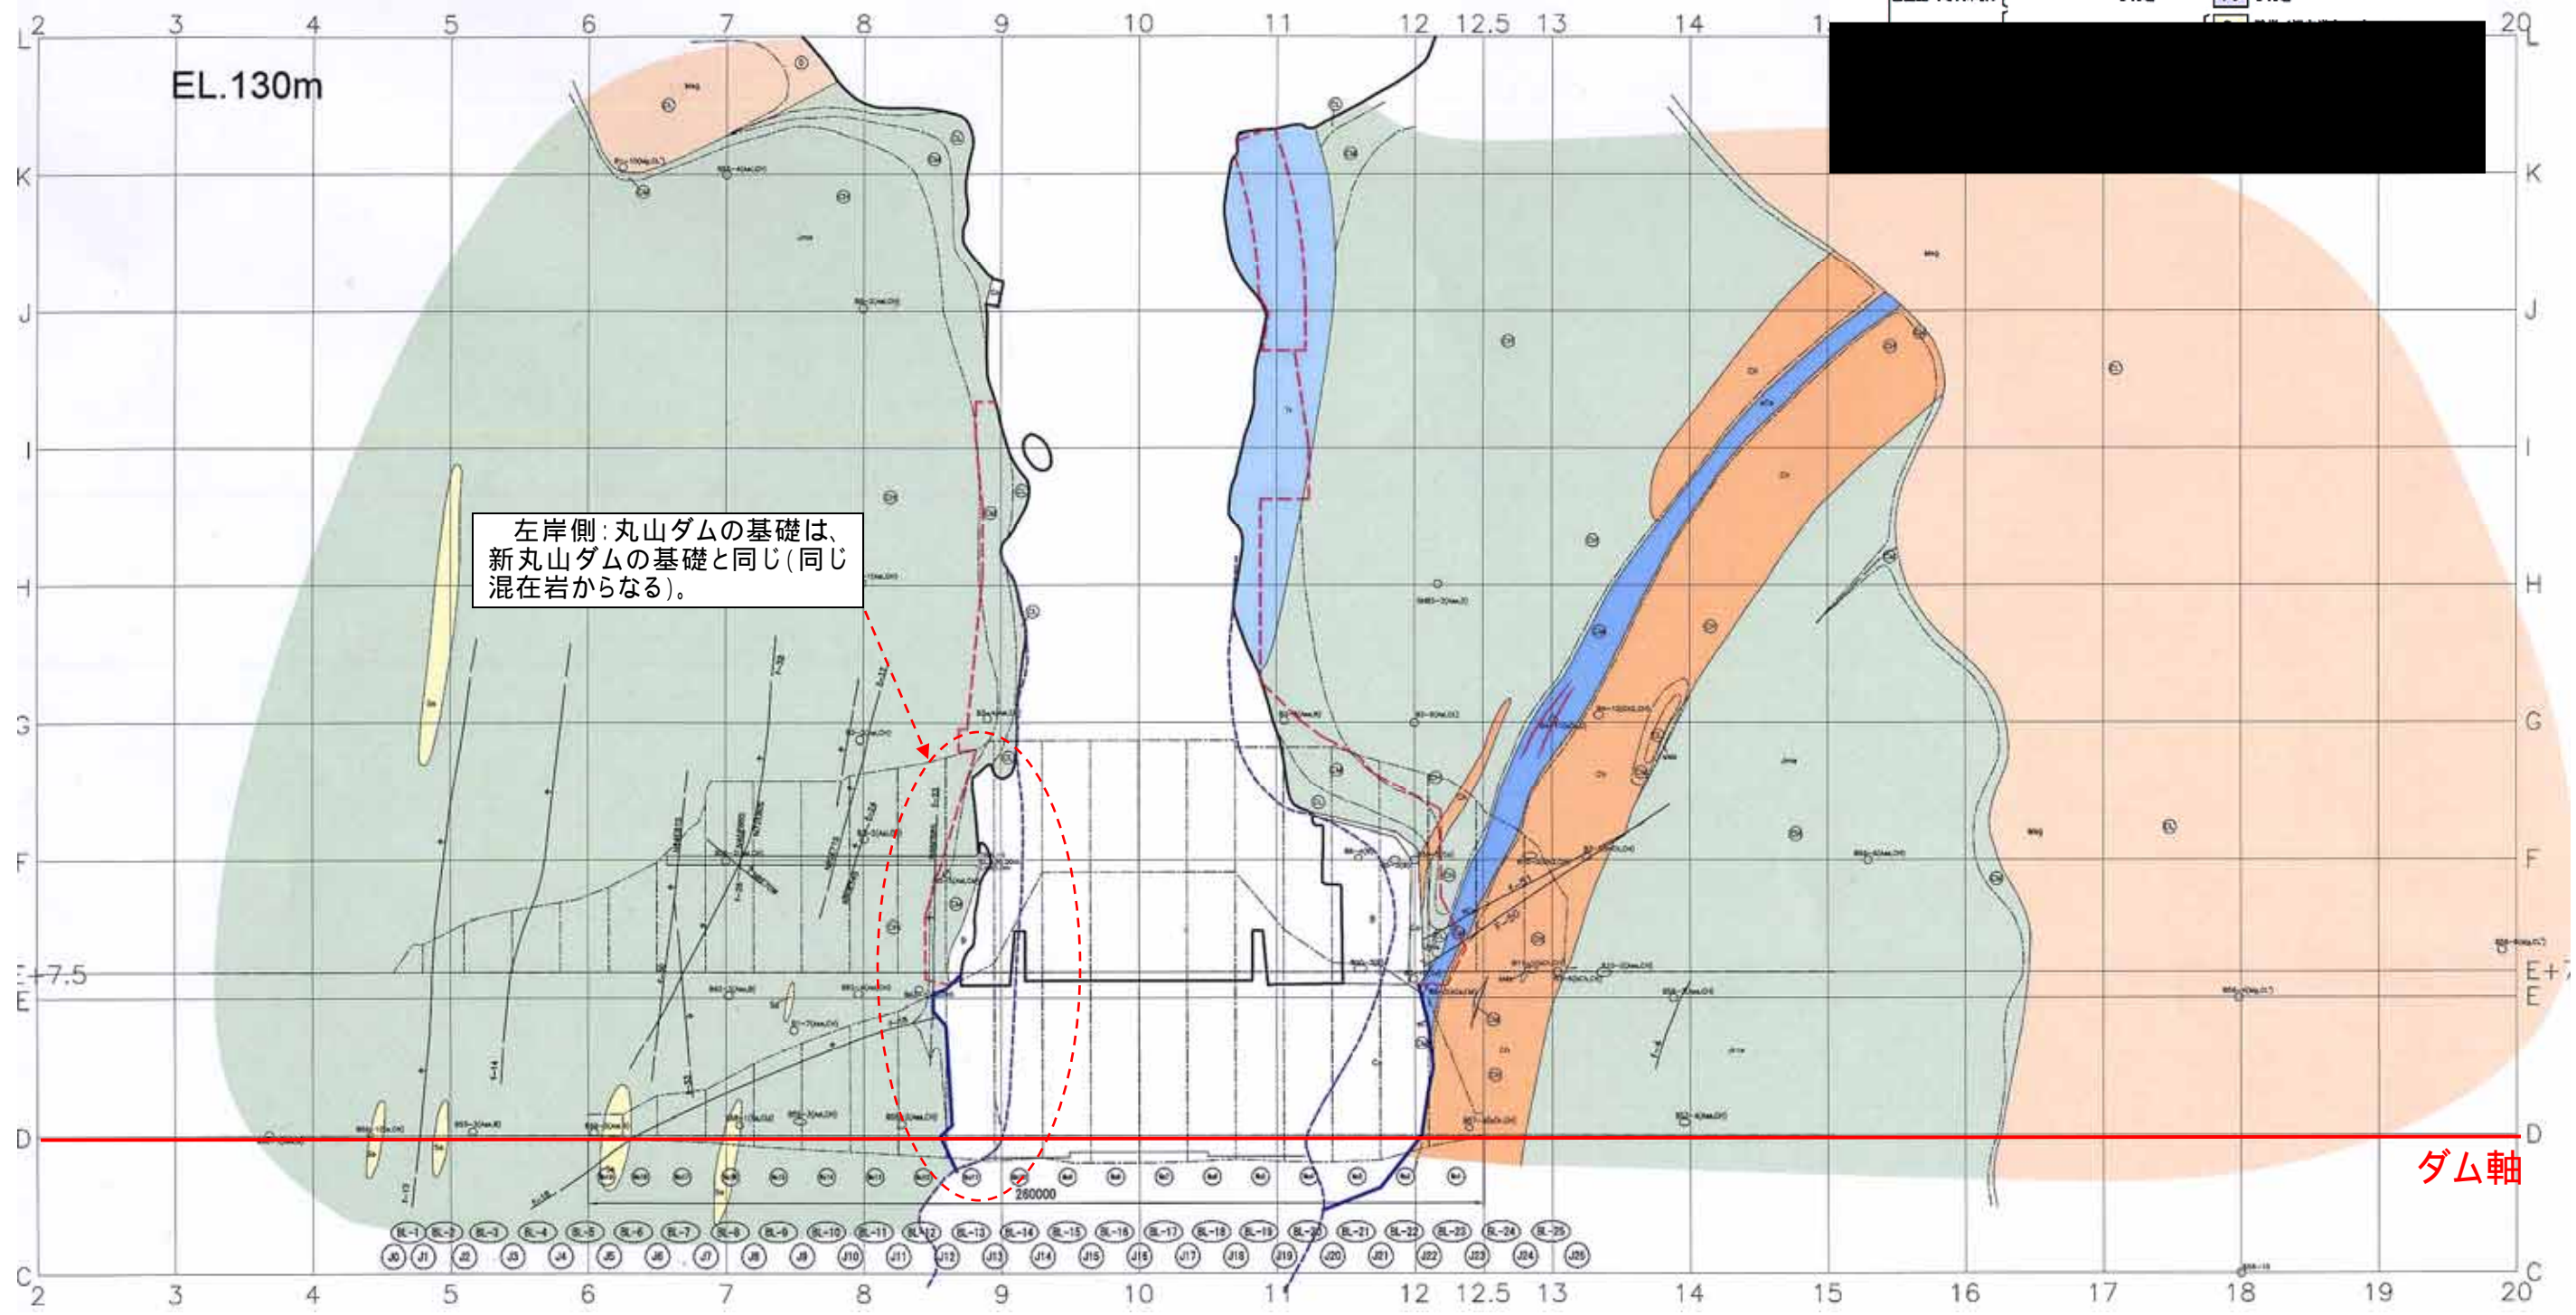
丸山ダムの基礎岩盤の状況 (EL.130m 地質水平断面図)
